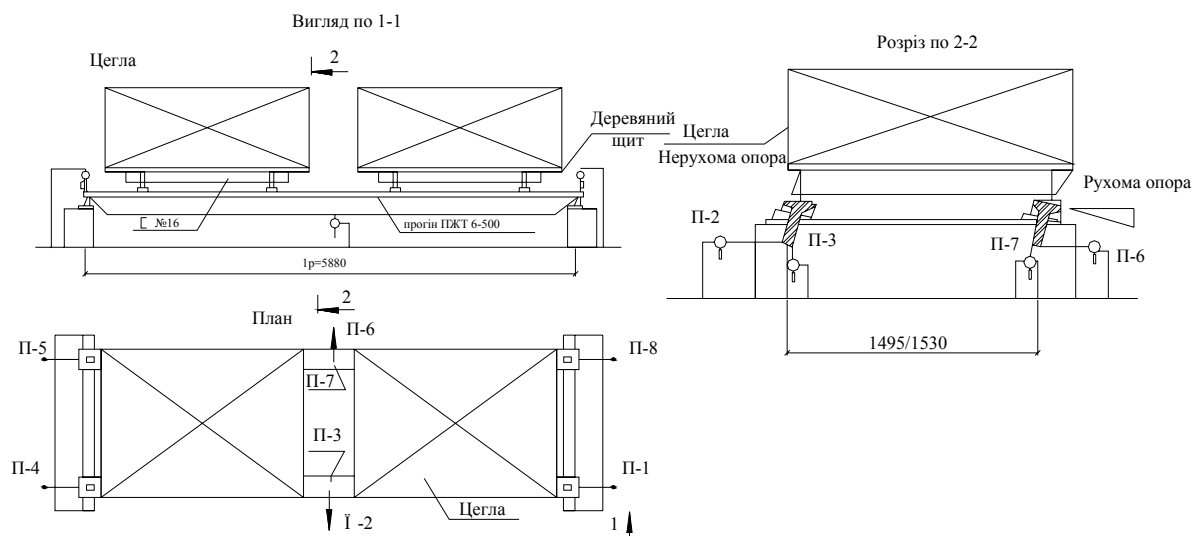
Схема навантаження та розташування приборів при випробуванні залізобетонних прогонів
